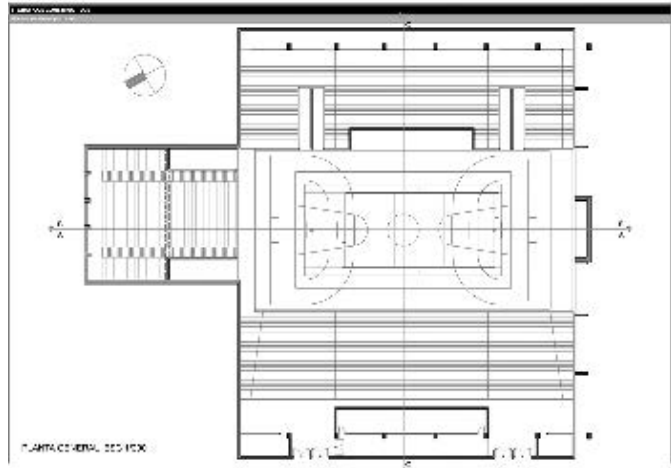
ELADIO DIESTE: PLANTA DEL GIMNASIO.
